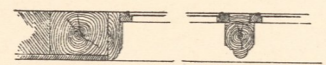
Wonsbeck. Wohnhausfenster. Grundriss. 1:30.
